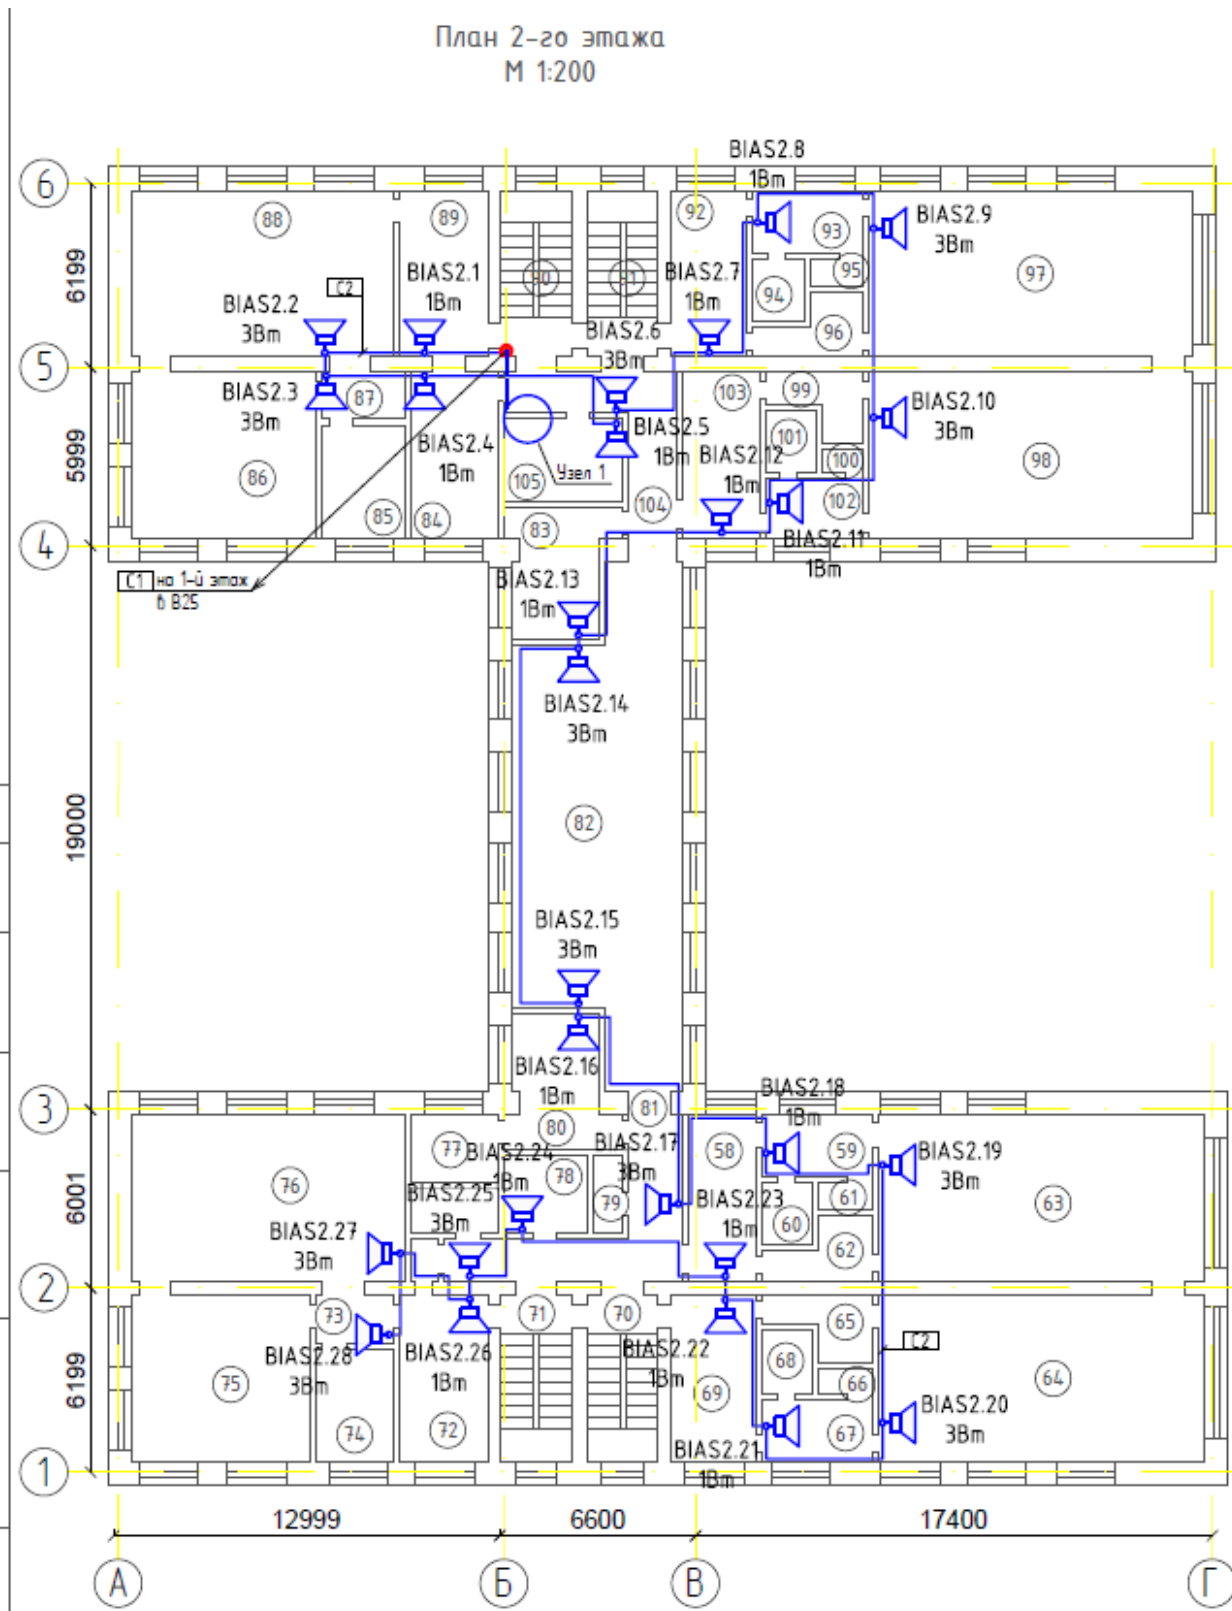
План 2-го этажа сети звукового оповещения о пожаре
